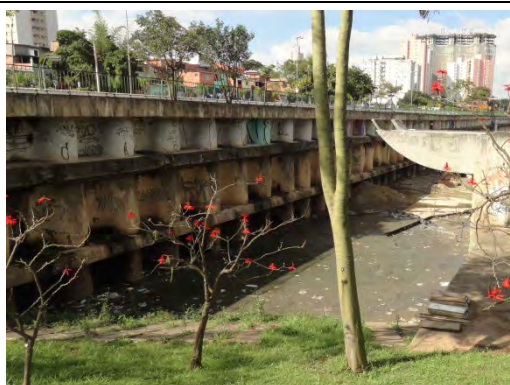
Vista geral a montante do córrego Água Espraiada – APP 12.
